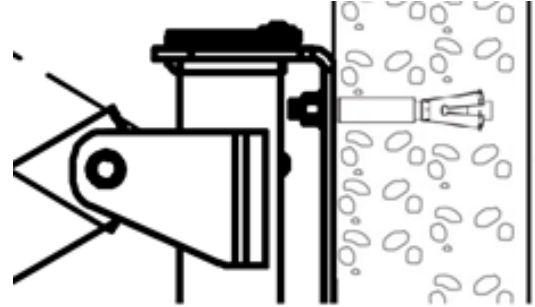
Anclaje con perno expansivo en muro 100% hormigón
